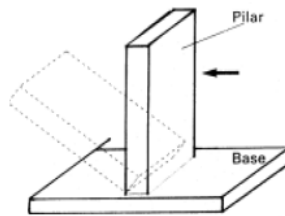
Elemento estructural de tipo pilar ²⁴
